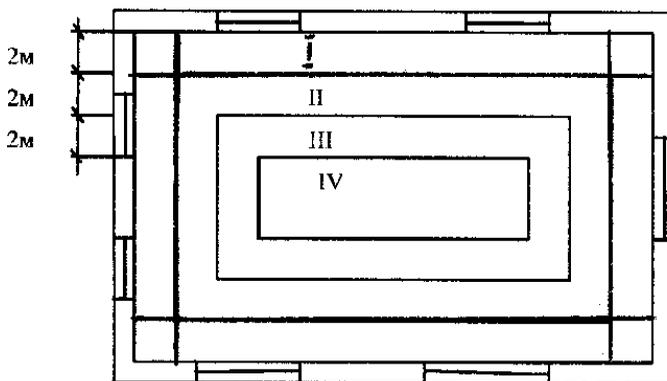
Схема деления площади пола на грунте или на лагах на зоны при расчете теплопотерь
